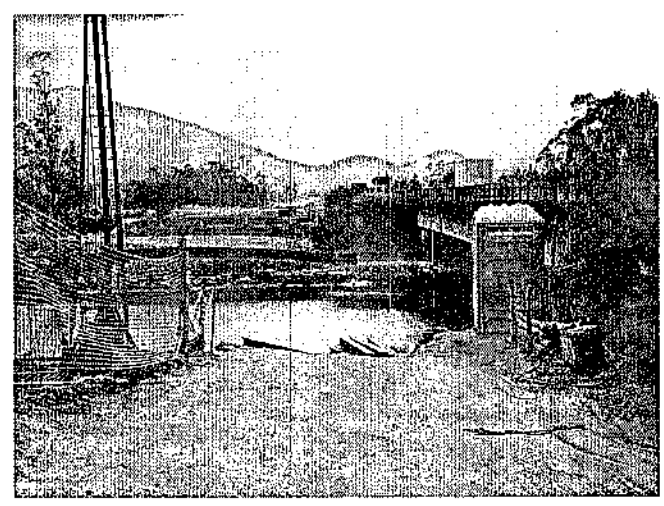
Ponte sobre o Rio da Madre, divisa dos Lotes 22 e 23/SC
